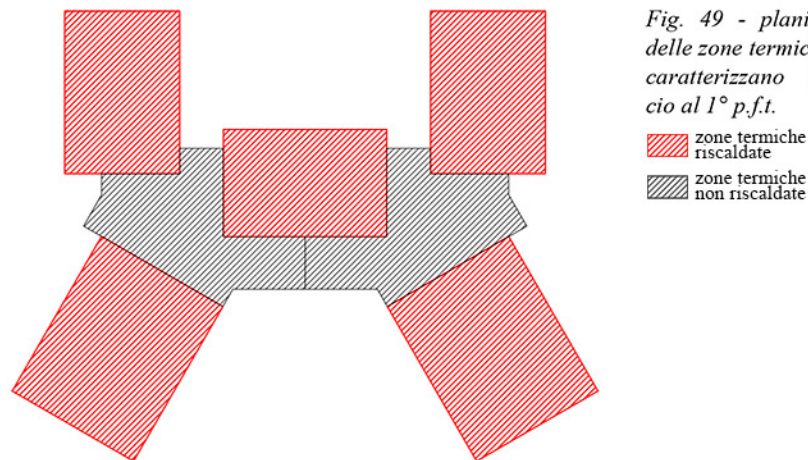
planimetria delle zone termiche che caratterizzano l'edificio al 1° p.f.t.
